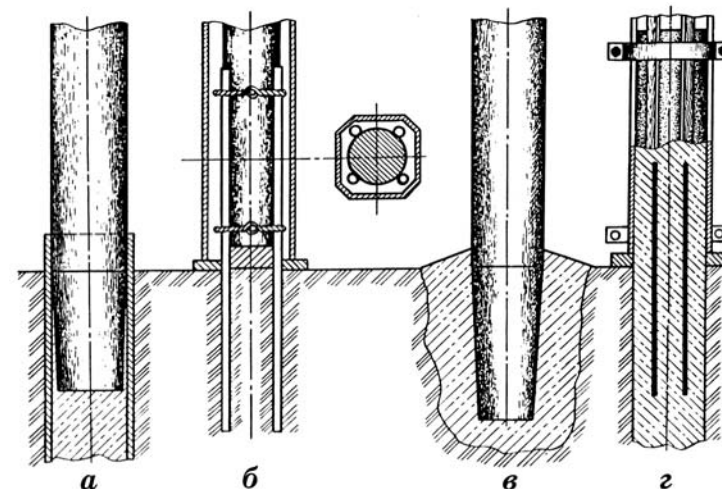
Примеры крепления в грунте опор конструкций, подверженных ветровой нагрузке: а – с погружением в металлическую трубу, закопанную в землю и залитую бетоном; б – с зажатием проволочной закруткой между четырьмя металлическими стержнями (трубами, уголками, швеллерами), вбитыми или закопанными в грунт; в – с заливкой бетоном посадочного конца в яме (поверхность бетона выступает над уровнем грунта); г – с обжимом внешнего короба колонны полухомутиками вокруг цементного или бетонного столбика на арматуре.
